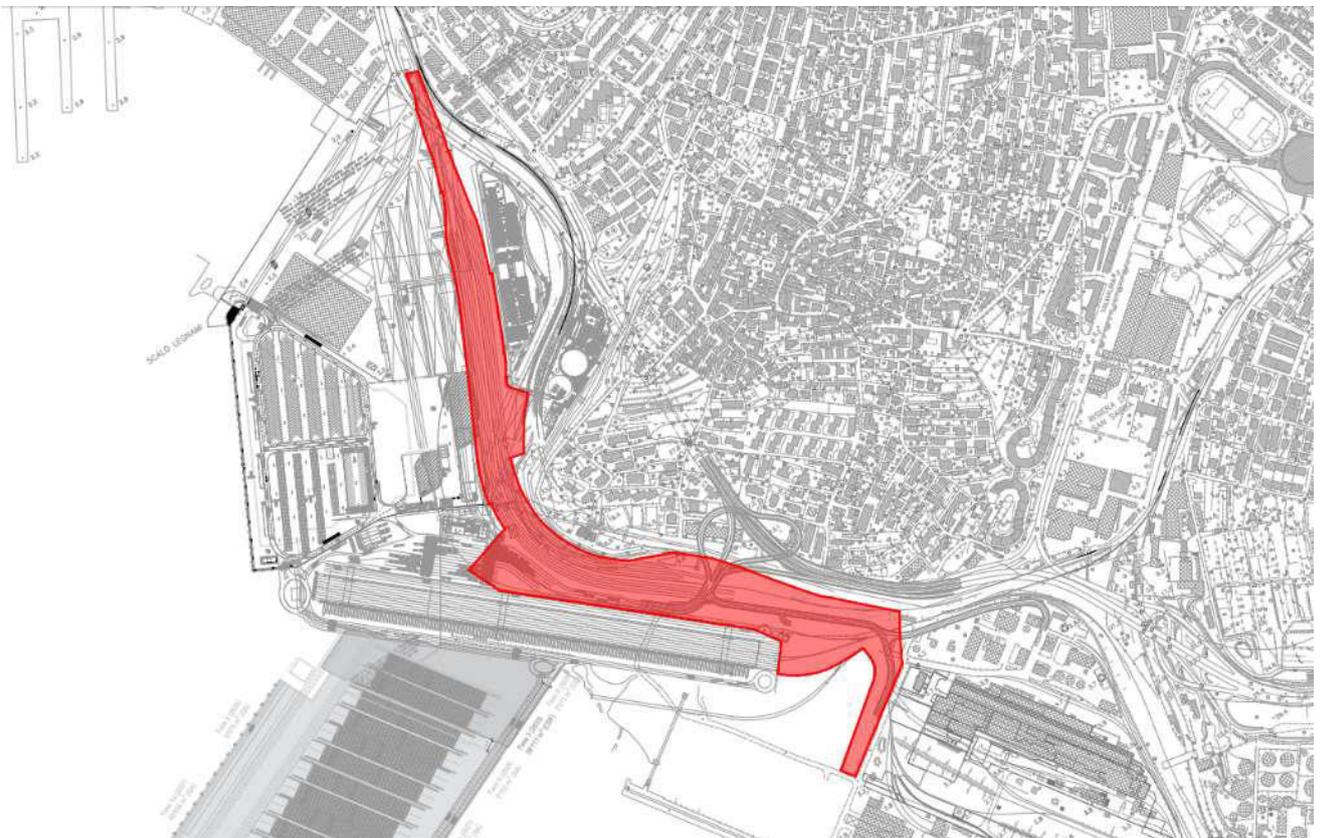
Planimetria Nuova stazione di Servola (2FER)
